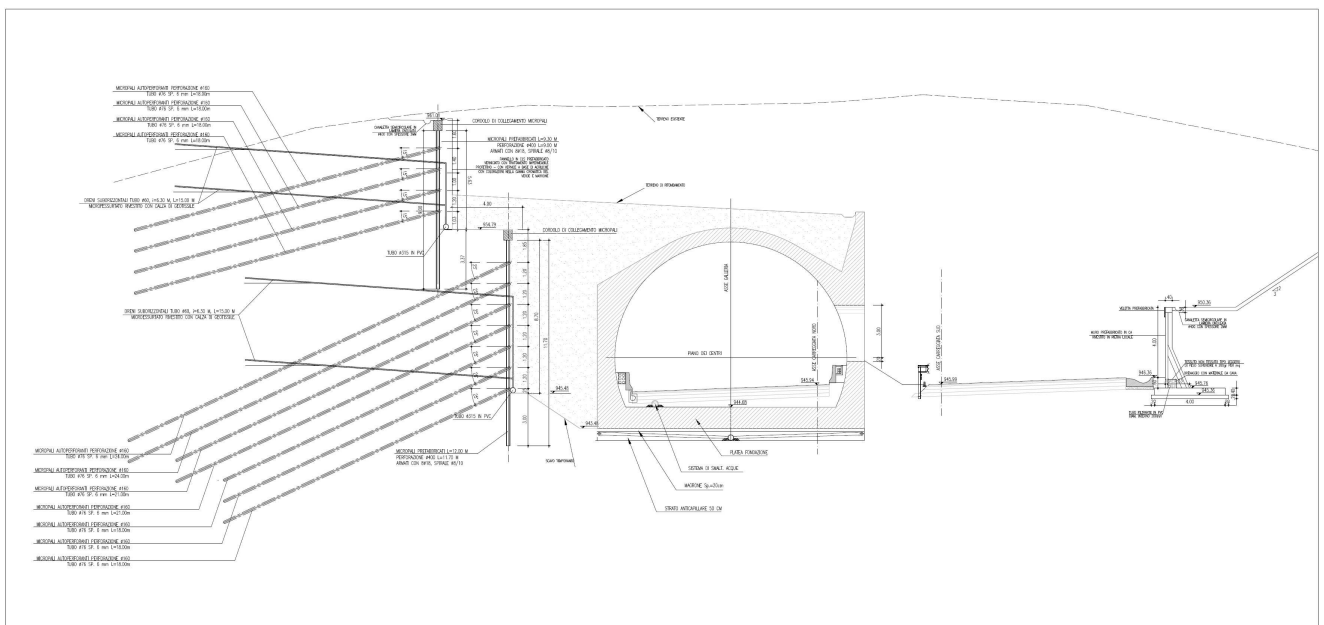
Sezione tipo Galleria Artificiale Calanchi I – Proposta di Variante
